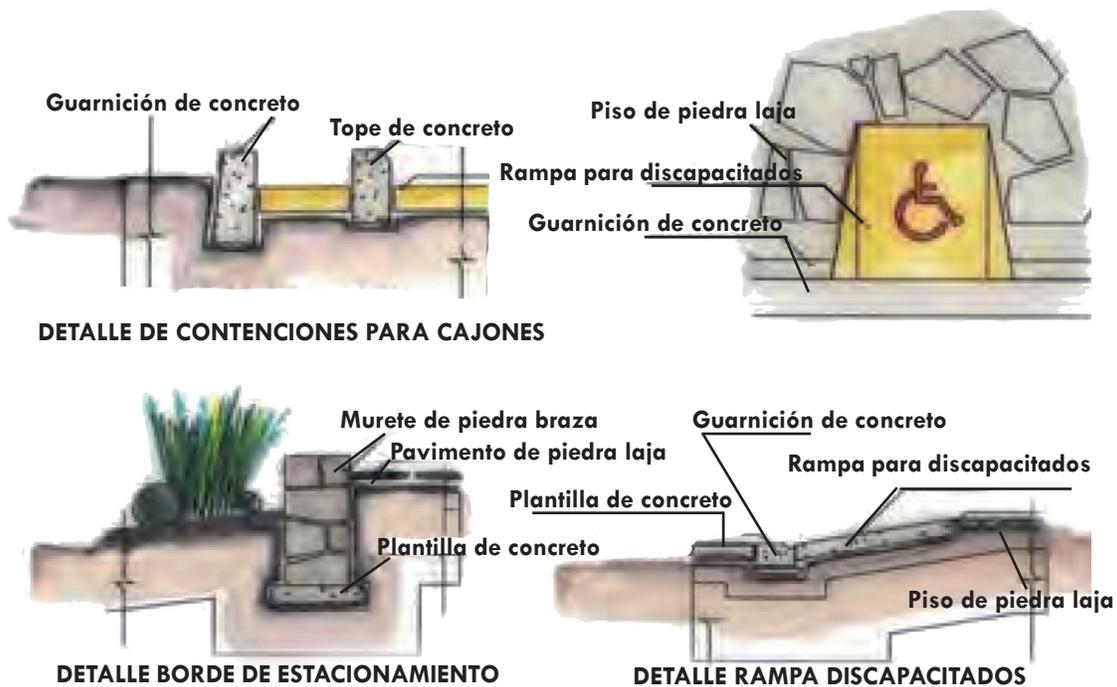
| Detalles constructivos para un estacionamiento en zonas naturales.⁴¹
